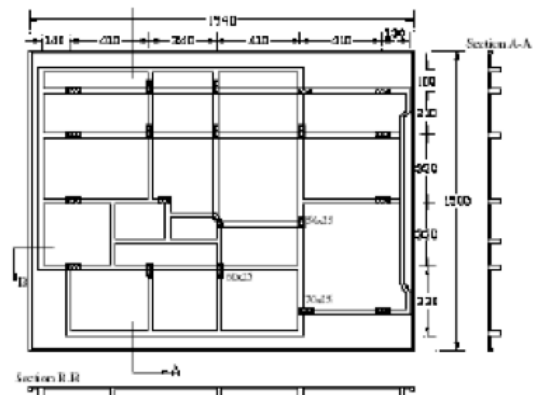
Planta de edificio irregular Columnas no alineadas (Fuente: EERI, 1999)
